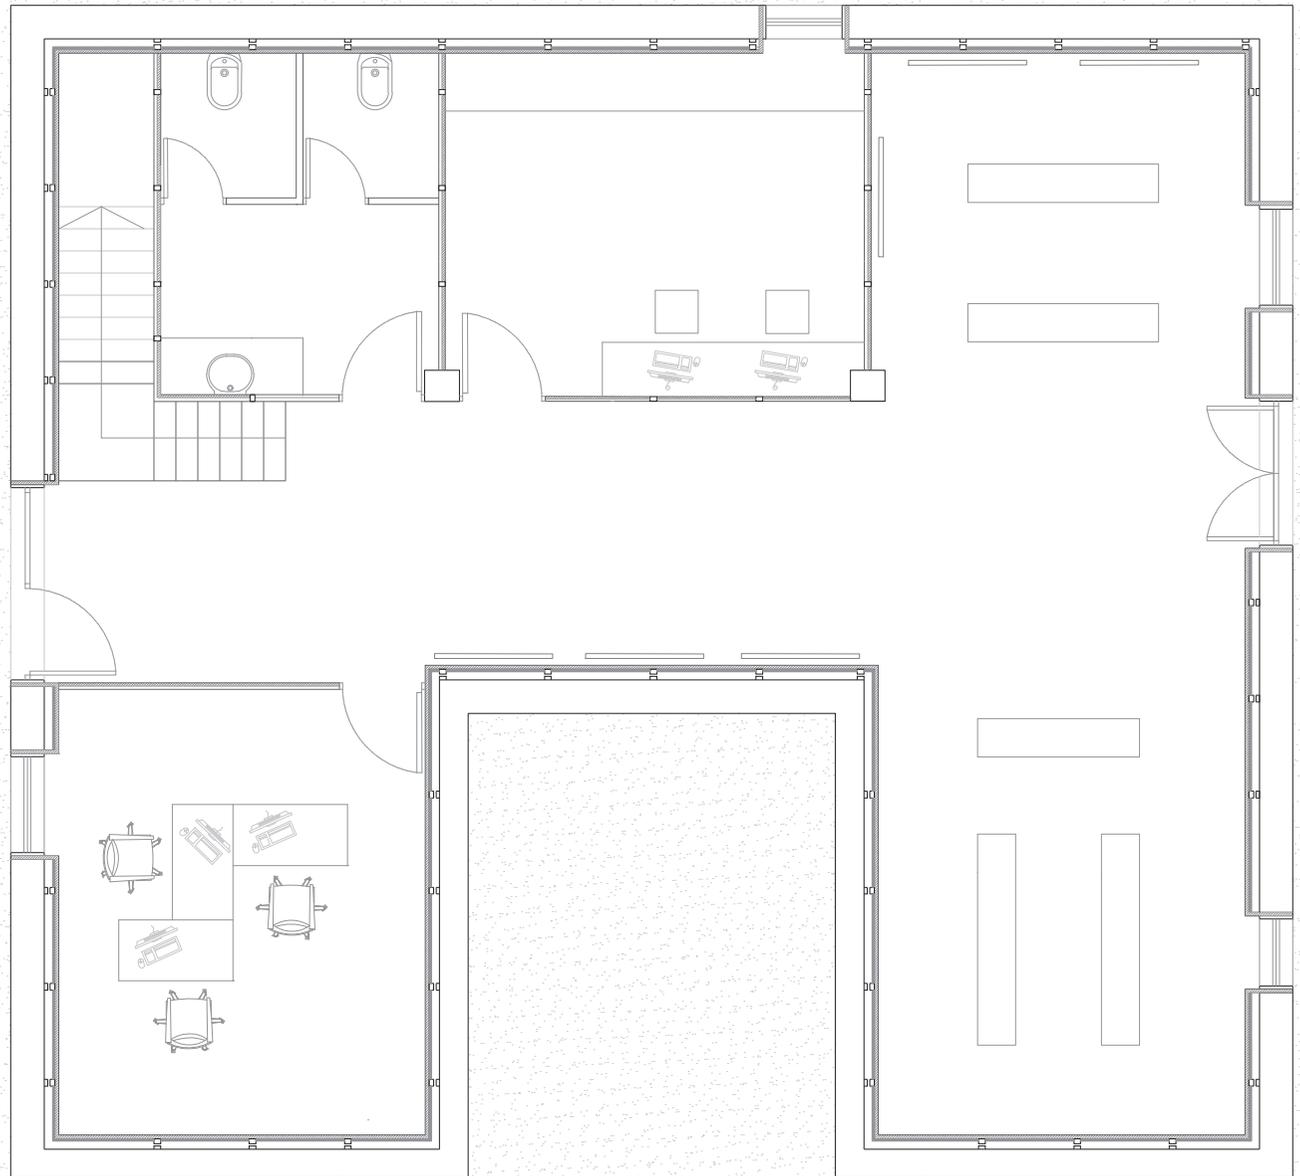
Planta baja proyecto. Escala 1/75. Fuente : Carlos Fuster Aparisi
